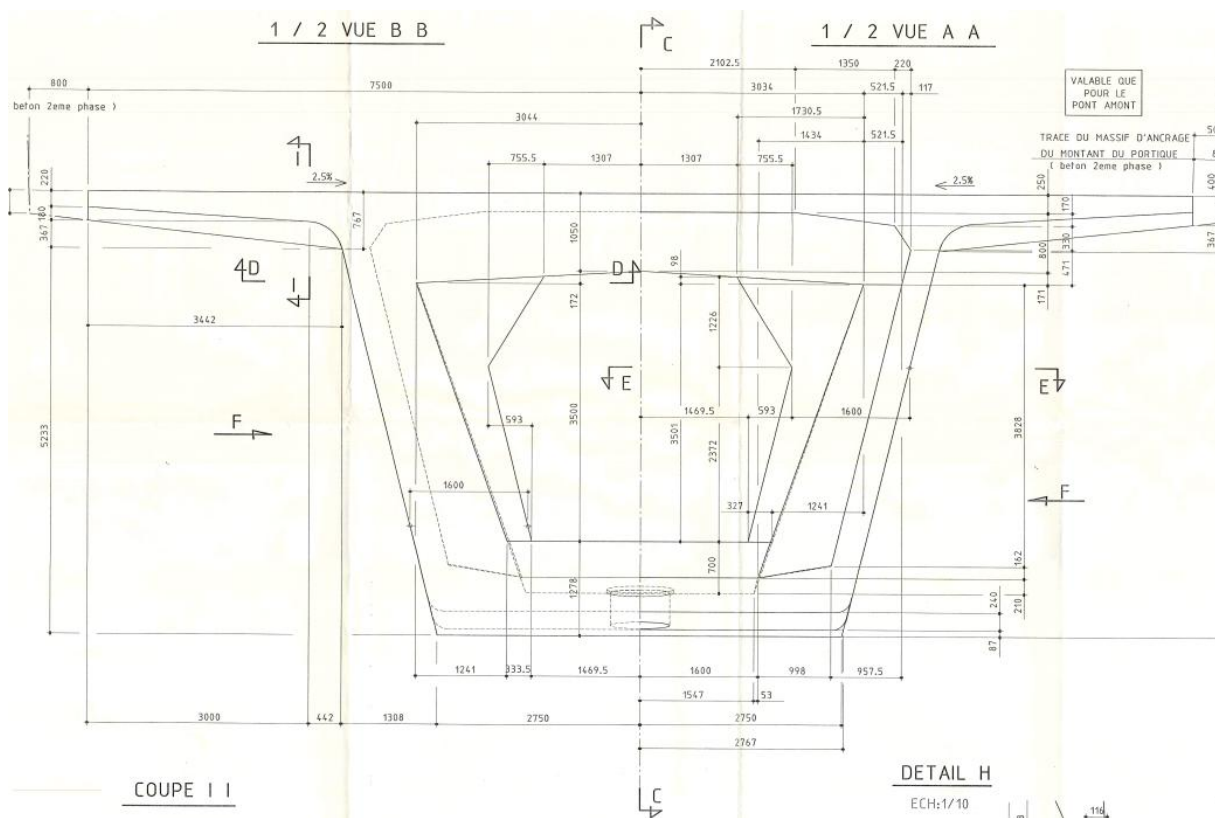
Coffrage voussoirs déviateurs en travée courante et travée de rive (extrait plan P411)
